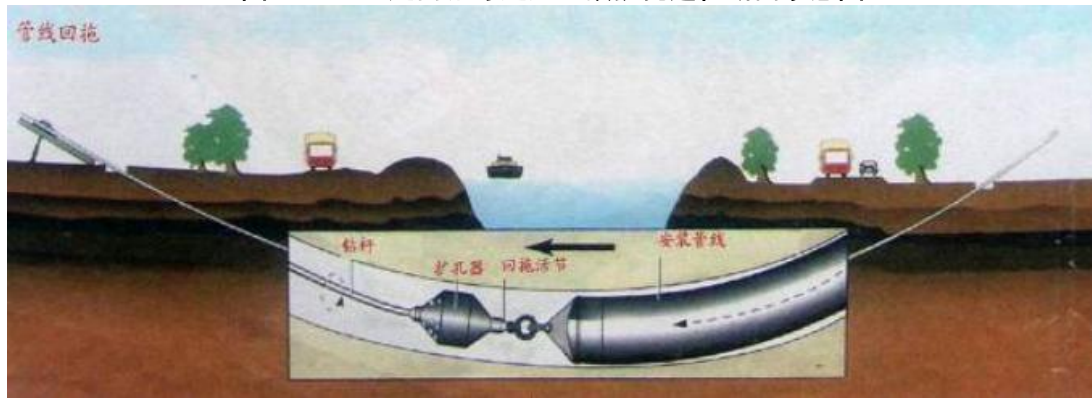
定向钻穿越施工管线回拖过程断面示意图
